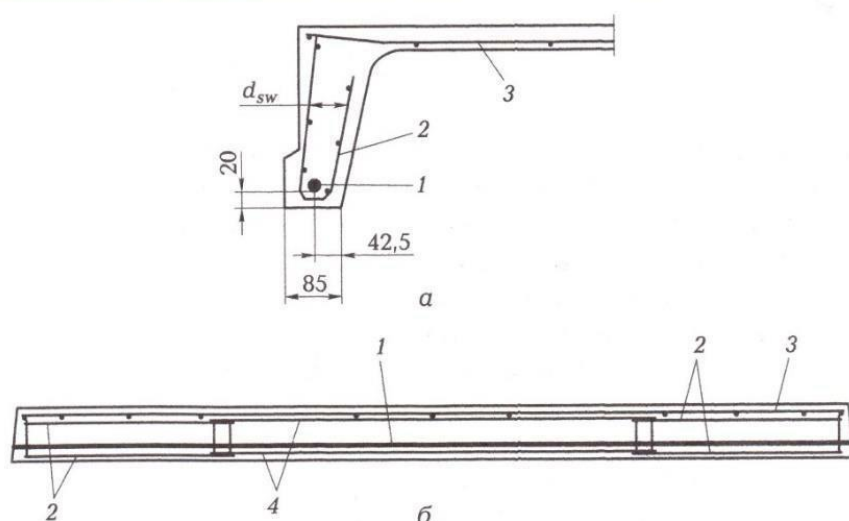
Армирование ребра плиты. К примеру 3.17:
